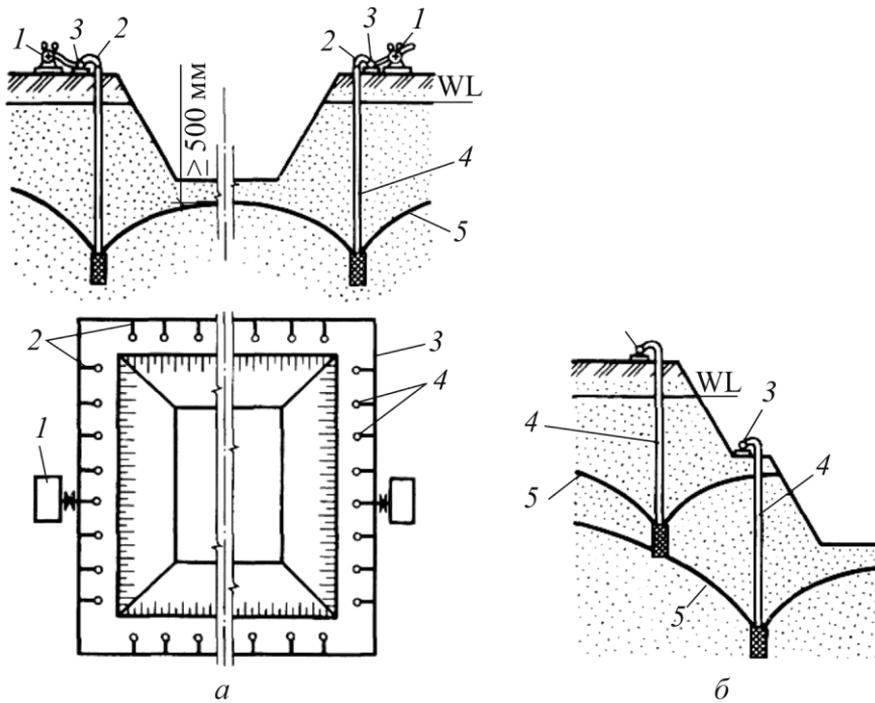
Схемы глубинного водопонижения: *а* – одноярусное расположение иглофильтров; *б* – то же, многоярусное; 1 – насосная станция; 2 – гибкие шланги; 3 – коллектор; 4 – иглофильтры; 5 – депрессионная воронка
